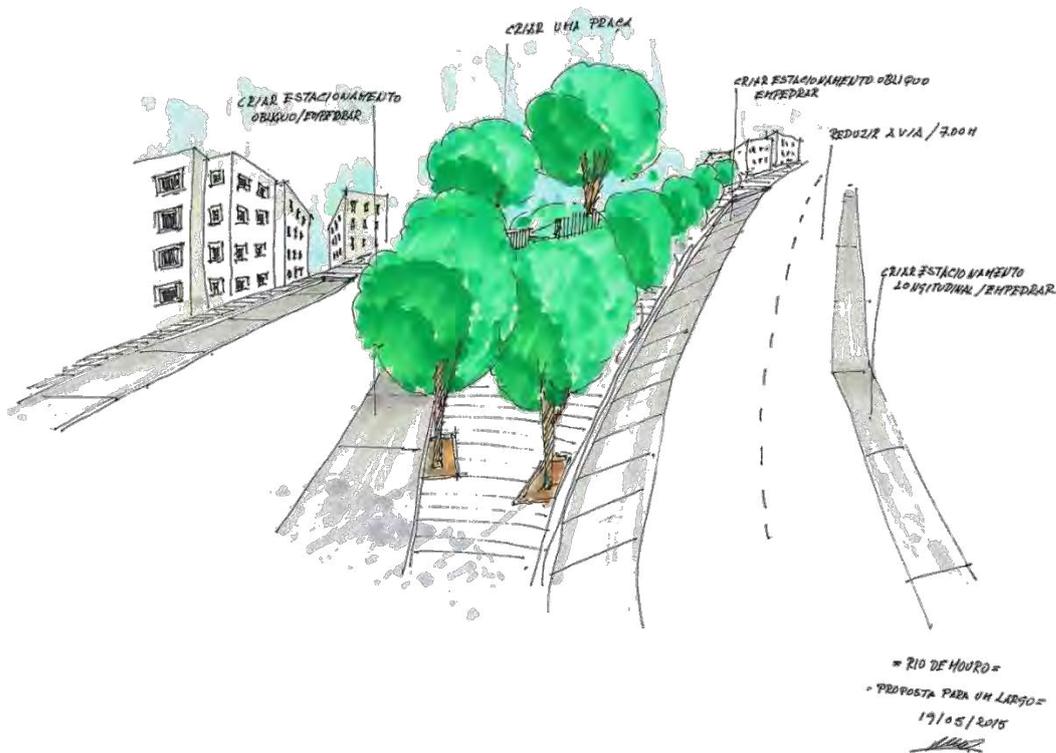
Proposta de Intenção para repavimentação da Calçada da Rinchoa e criação do Largo da Fonte do Rouxinol
